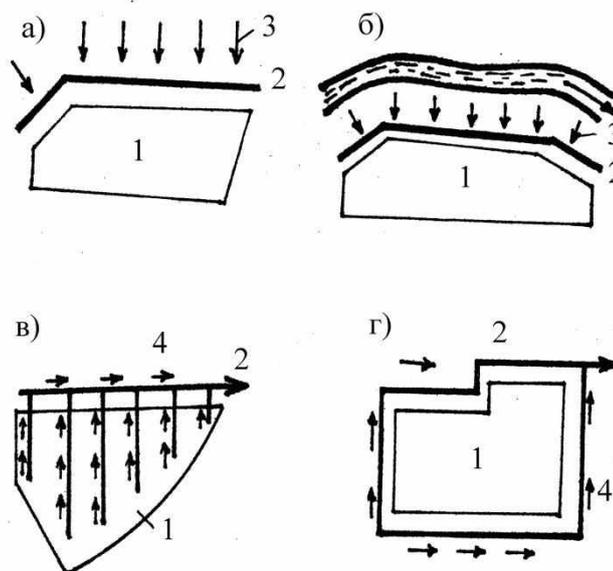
Схемы дренажей: (а-в)- общие системы; г- местные
